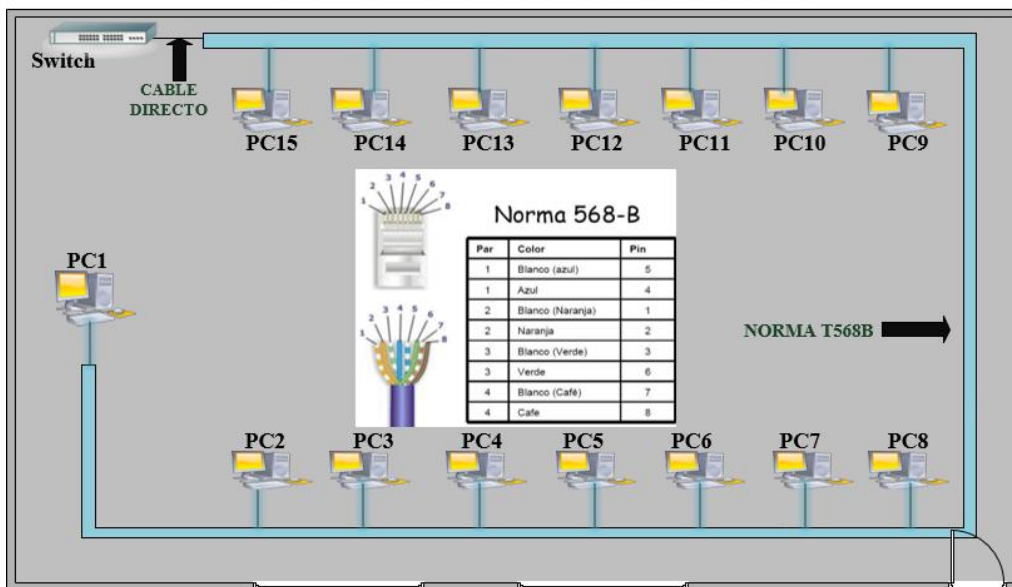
Plano de redes - Cableado Estructurado del Laboratorio de Informática
